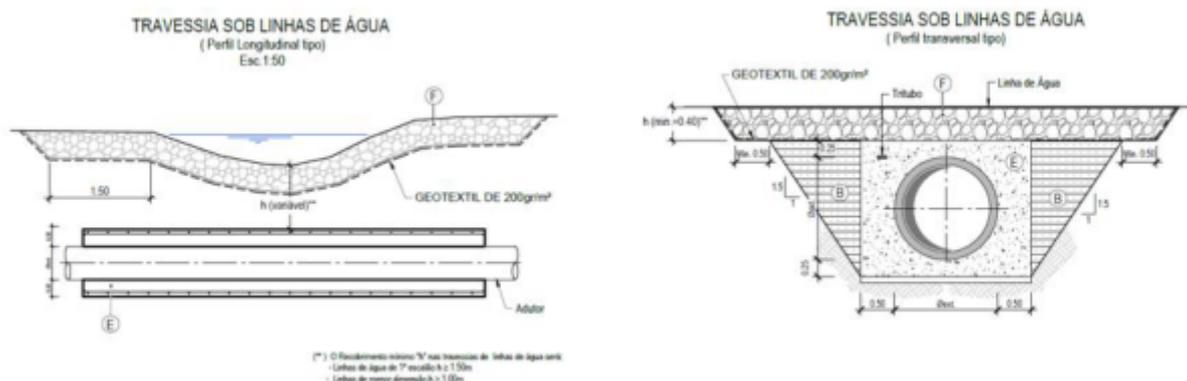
Cortes longitudinal e transversal da travessia sob as linhas de água. Excerto do Desenho 06 (PR-22357-CC) -Valas Tipo. Fonte: Projeto de Execução. Volume 2 – Conduta Elevatória, Tomo 2 – Peças Desenhadas
